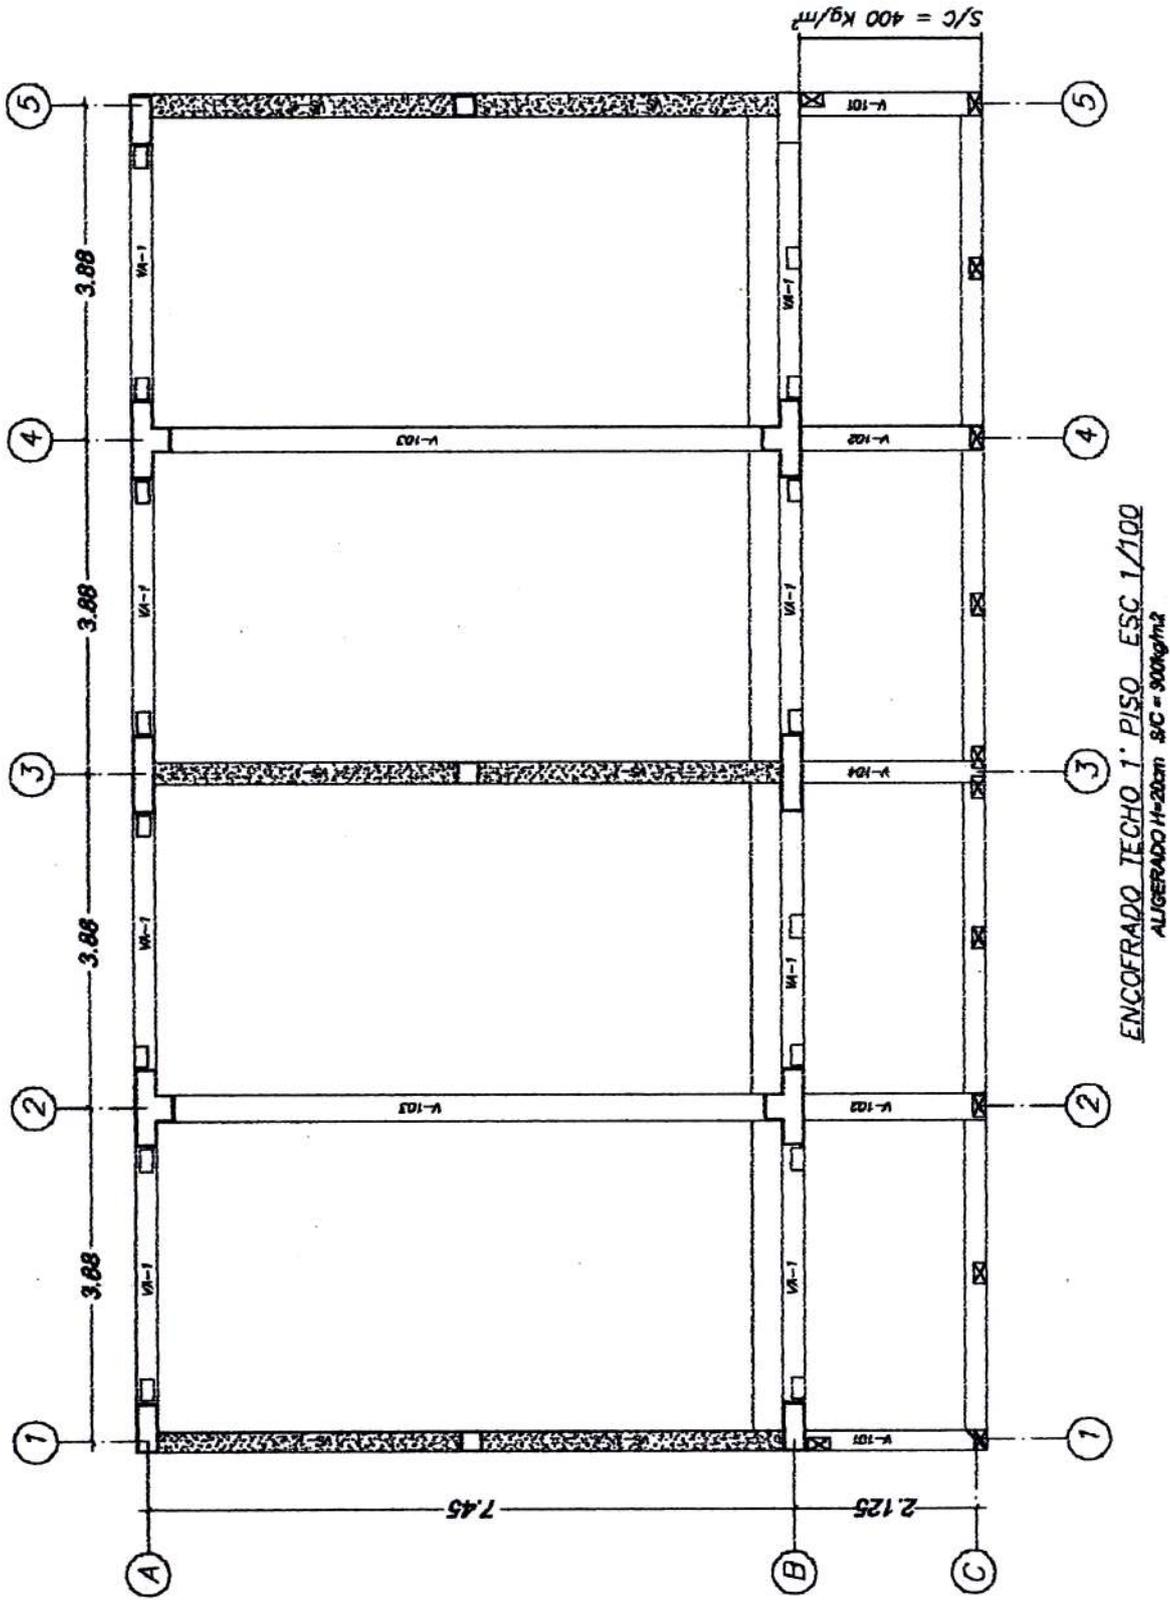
PLANTA ENCOFRADO DE TECHO 1° PISO – MODULO 2 AULAS-2 PISOS (ESC 1/100)
